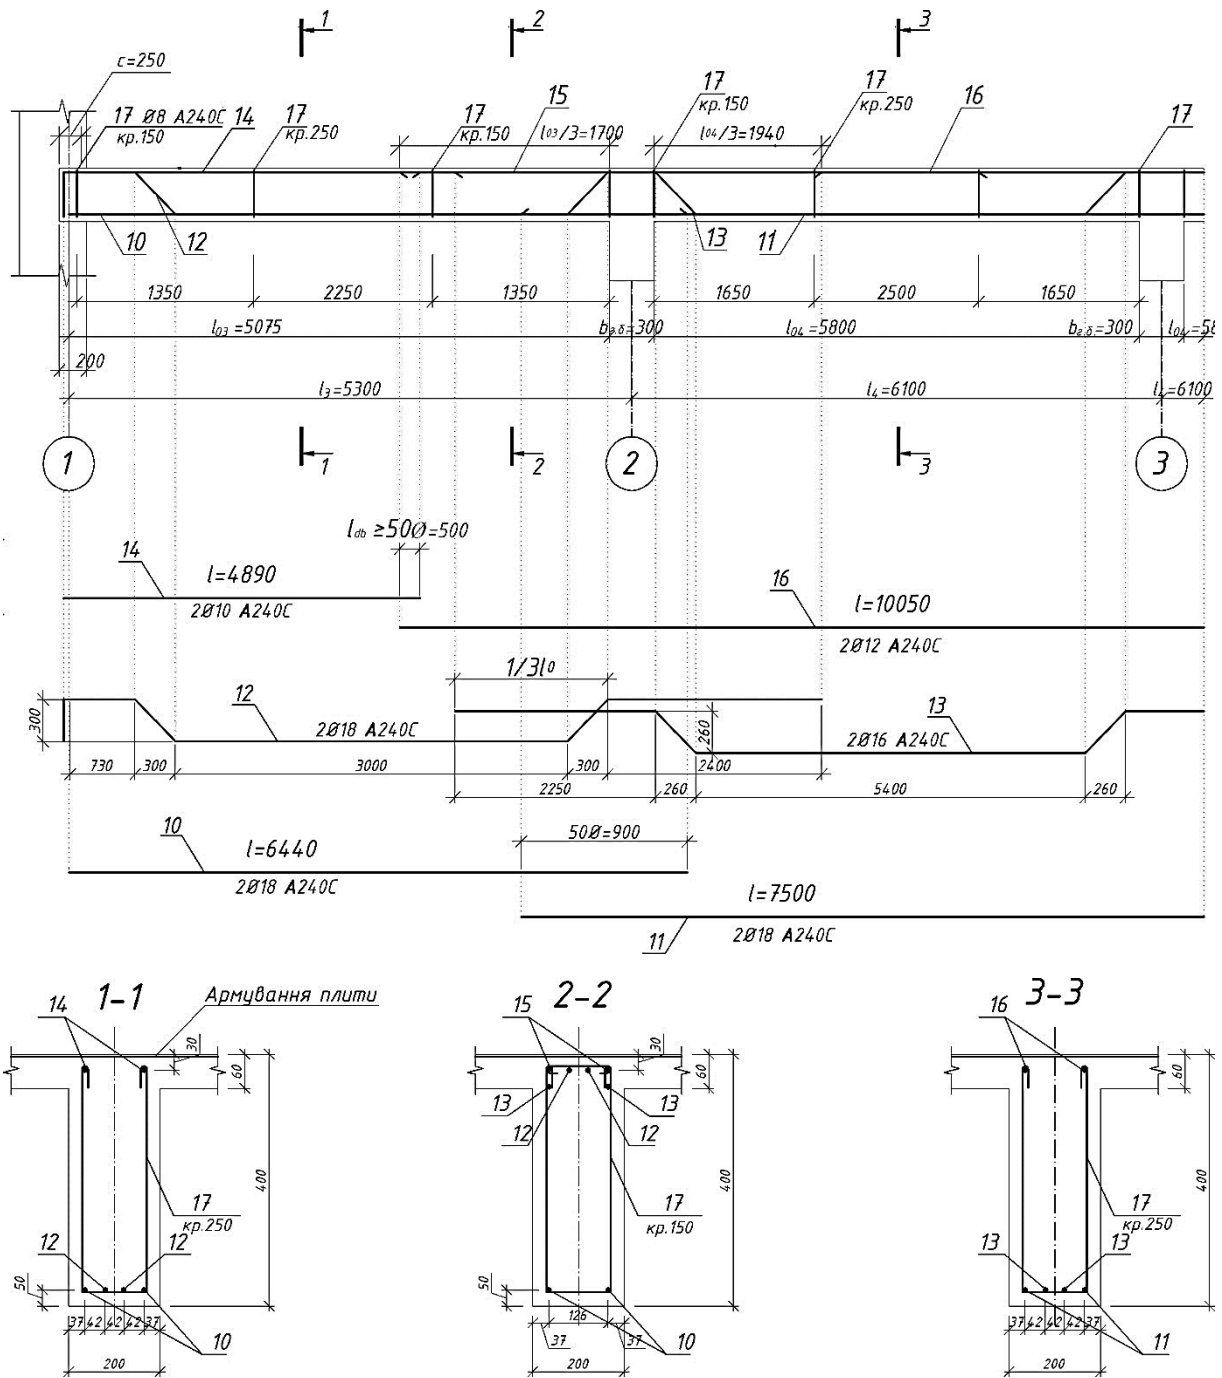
Армування другорядної балки в'язаними каркасами (окремими стержнями)
